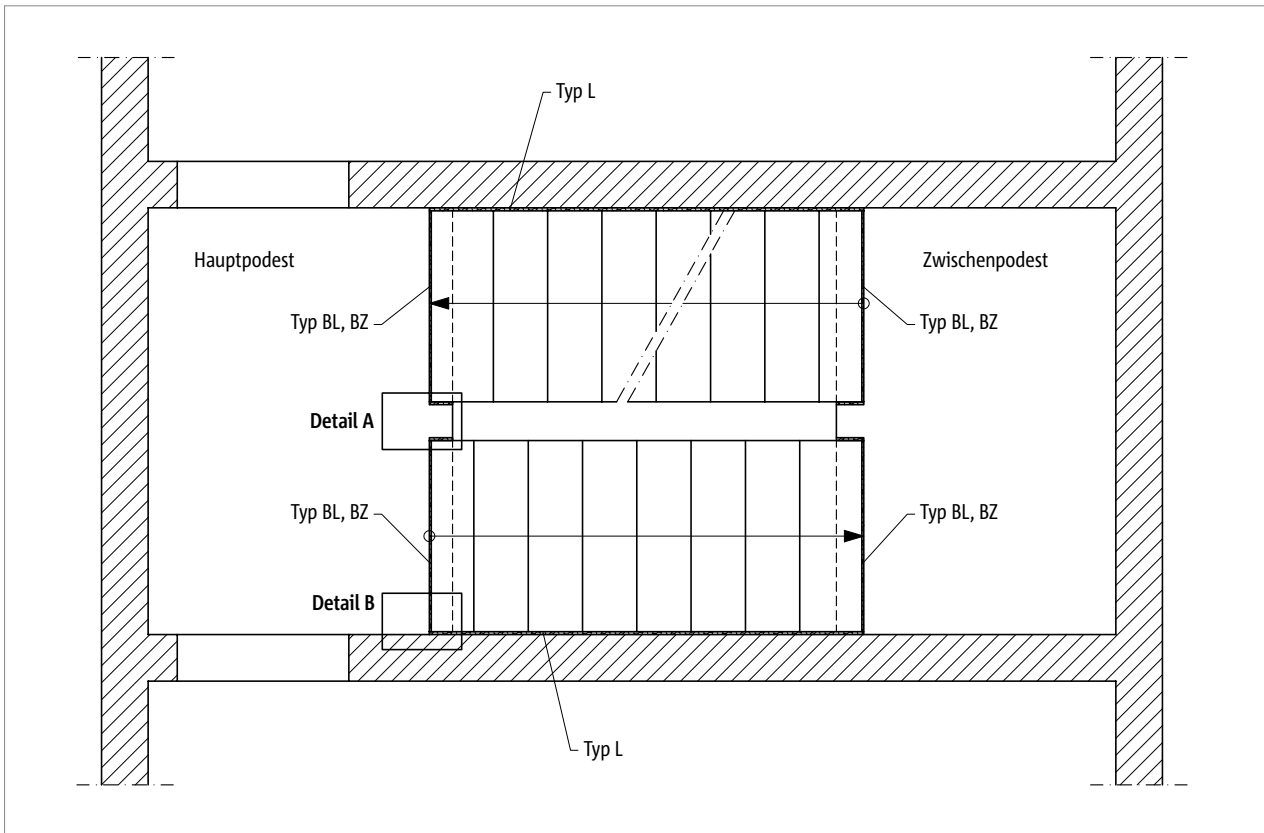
Schöck Tronsole® Typ BL, BZ: Elementanordnung im Grundriss
